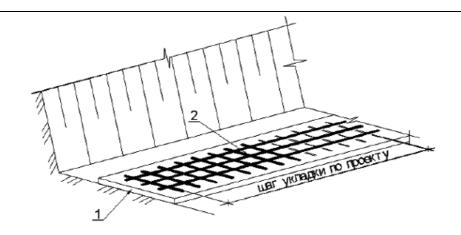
Укладка нижней сетки горизонтальных арматурных стержней
